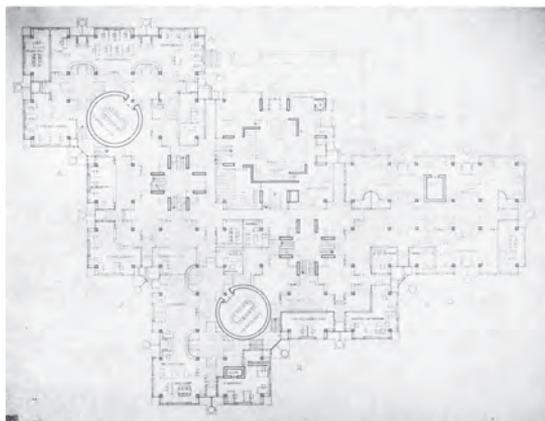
Herman Hertzberger. Planta de acceso del proyecto para el Ayuntamiento de Valkenswaard. *Tijdschrift voor Architectuur en Beeldende Kunsten* n° 5. 1967.
